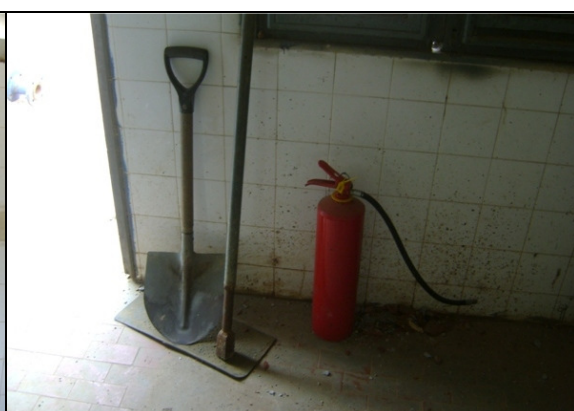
Extintor de incêndio da elevatória EEAT-01.
